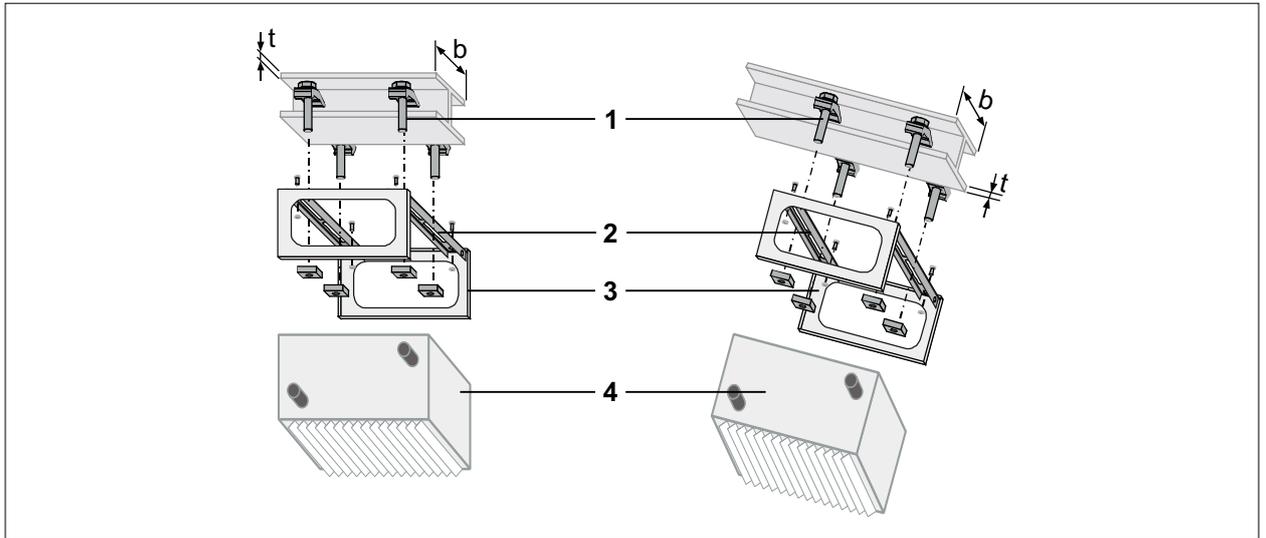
Montaje del aerotermo directamente en la viga de acero
